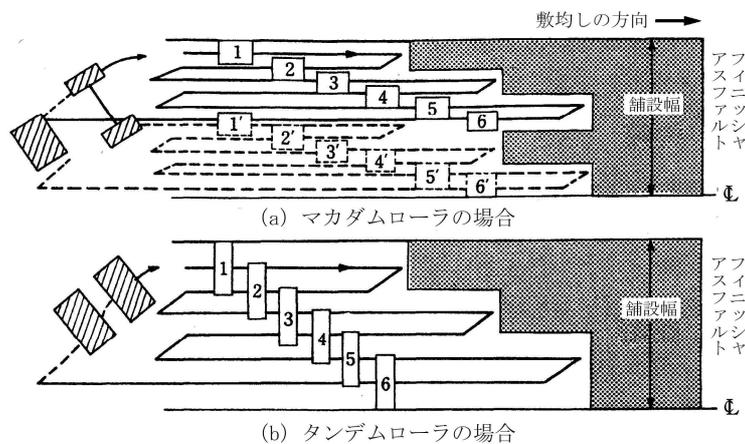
ロードローラによる転圧方法の一例⁵⁾
